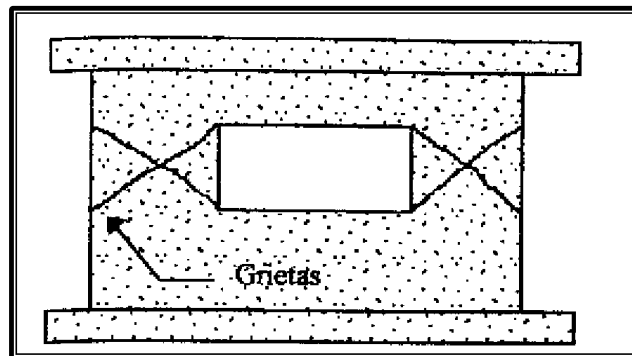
grietas a 45 grados formando una X en las partes del muro que rodean la abertura. (Falla por cortante en muros con aberturas)
